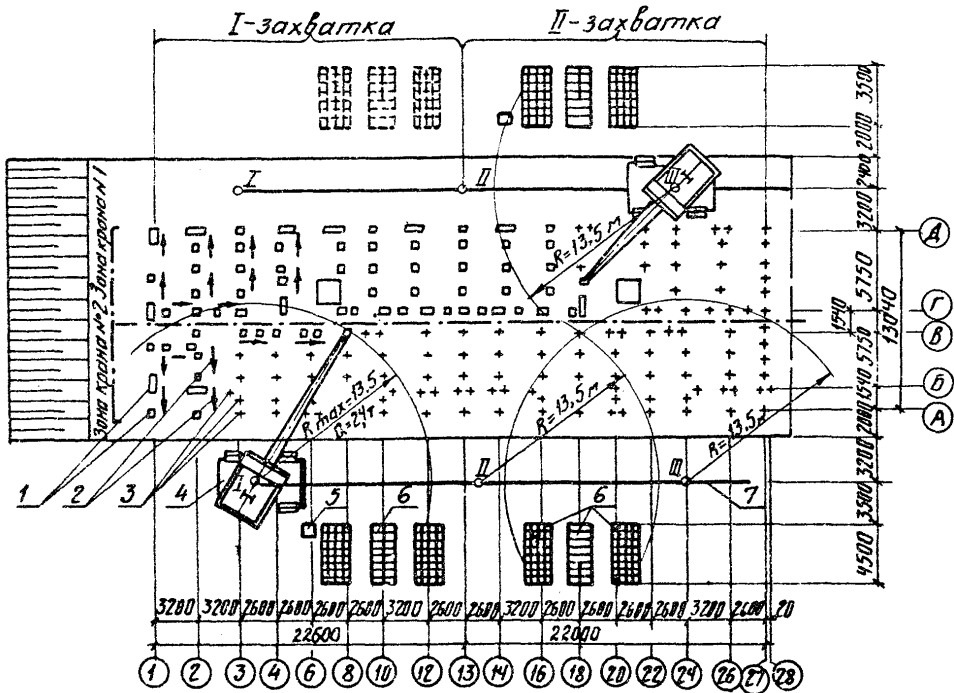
Схема организации работ по монтажу оголовков: I-смонтированные оголовки; 2-направление монтажа; 3-забитые сваи; 4-пневмоколесный кран К-161; 5-лещик для приема бетона; 6-штабеля оголовков; 7-ось движения крана; I, II, III - стоянки крана
